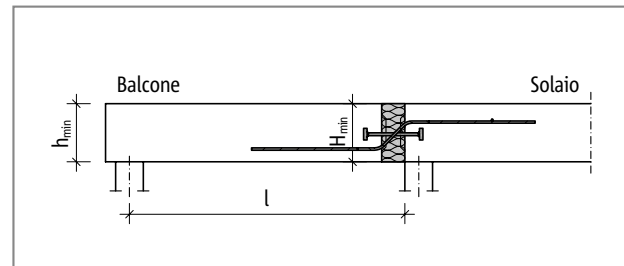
Schöck Isokorb® tipo QP80L: schema statico
